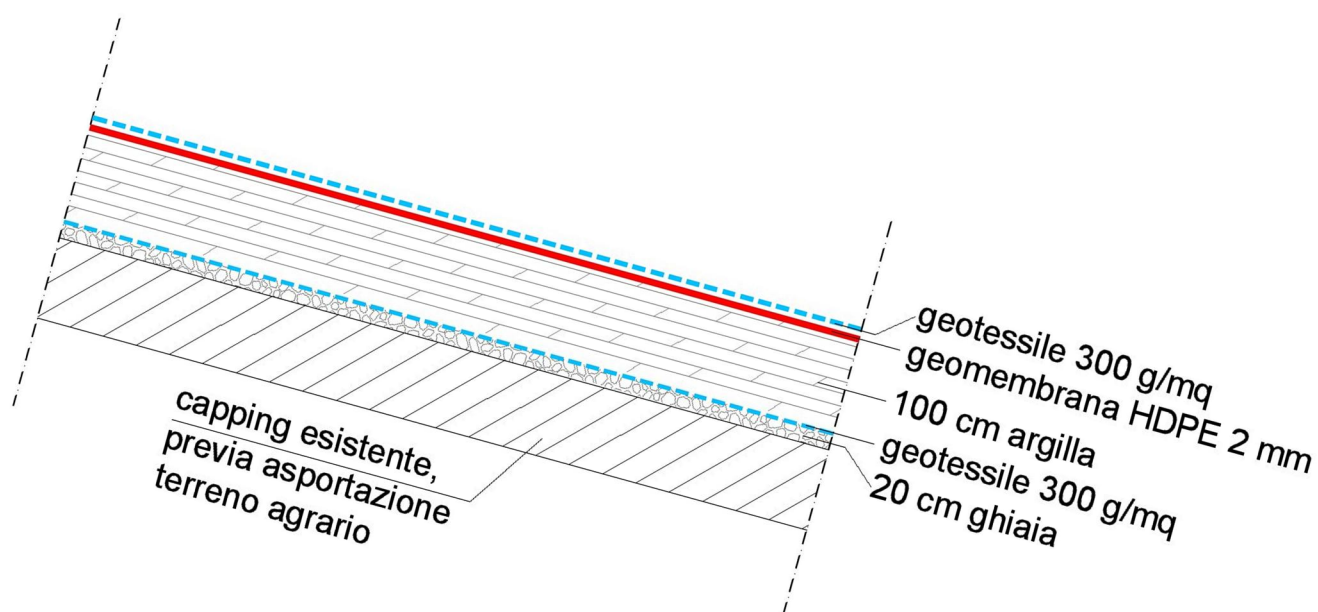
Particolare dell'impermeabilizzazione delle scarpate esistenti
